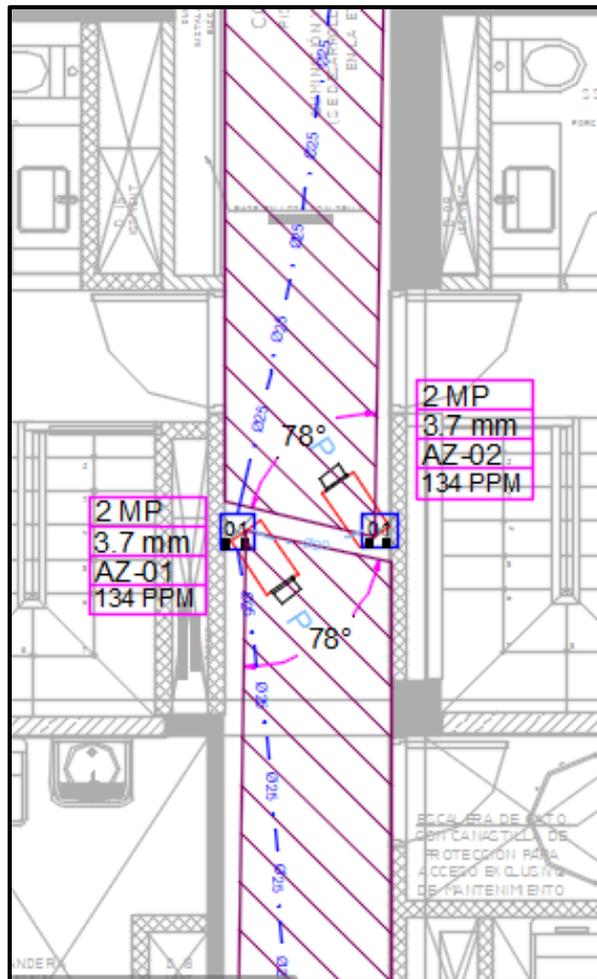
Ubicación de equipos en pasadizos de la azotea.
